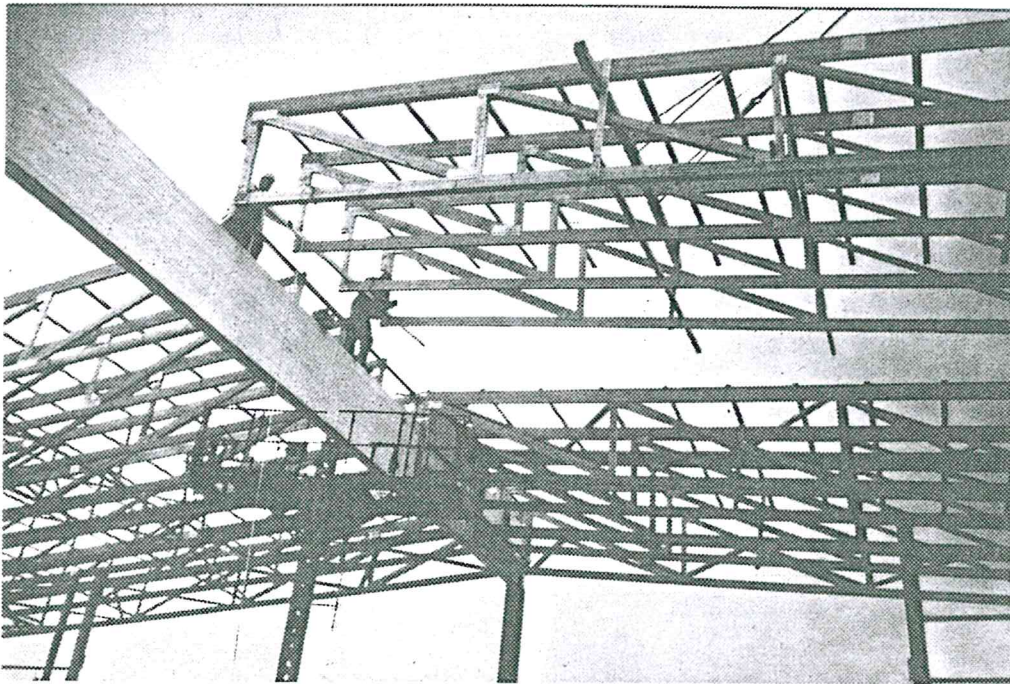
Montage einer Nagelplatten-Fachwerkbinder-Konstruktion
